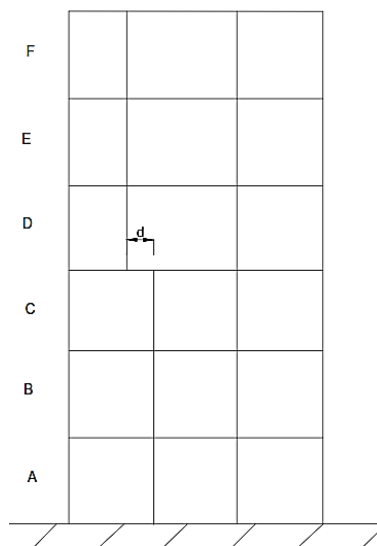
Desplazamiento dentro del plano de acción de los elementos verticales en un edificio.
